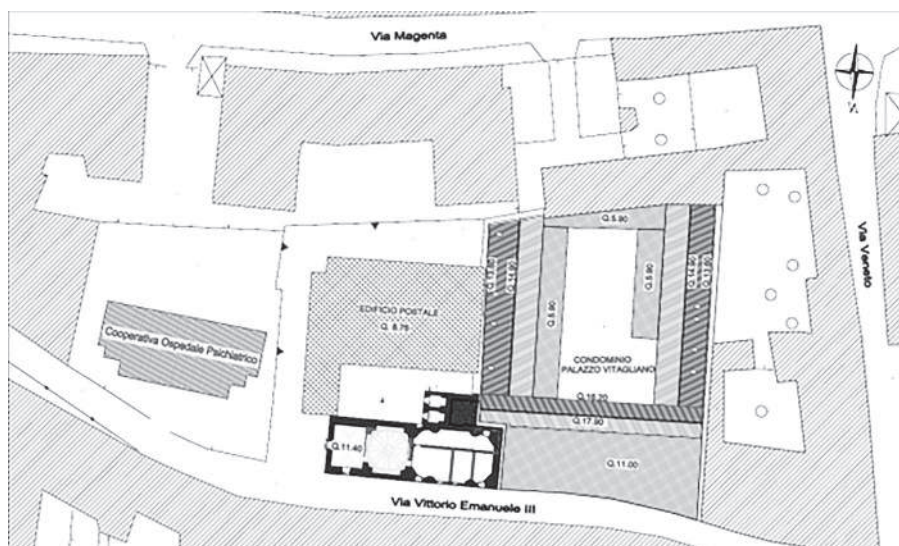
Stralcio planimetrico della succursale di Montevergine, già parte della sezione distaccata femminile delle Reali Case de' Matti di Aversa, allo stato attuale [fornita dall'ingegnere R. D'Aniello].
